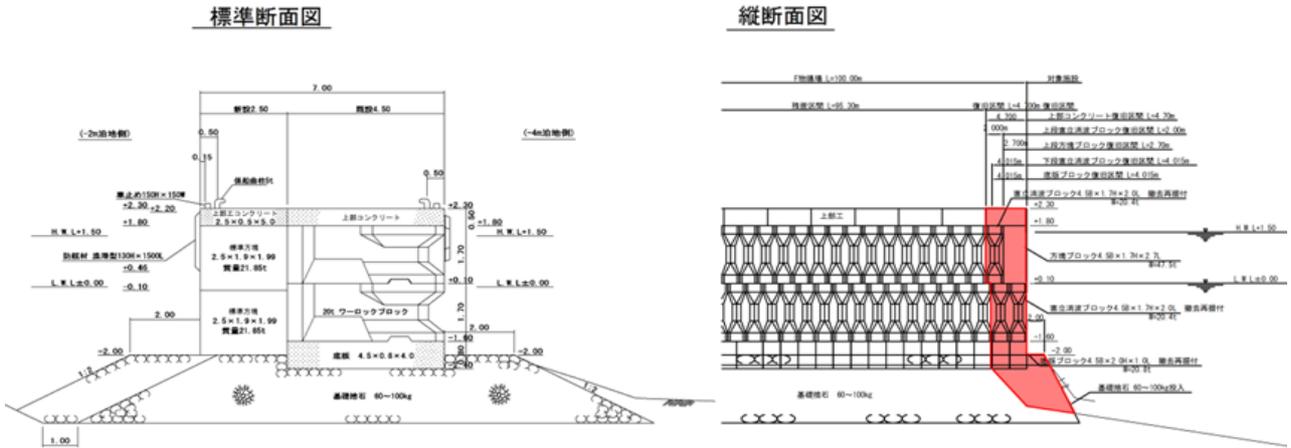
No.26 大洗港区_第1ふ頭地区 F物揚場の断面図 (復旧後)
